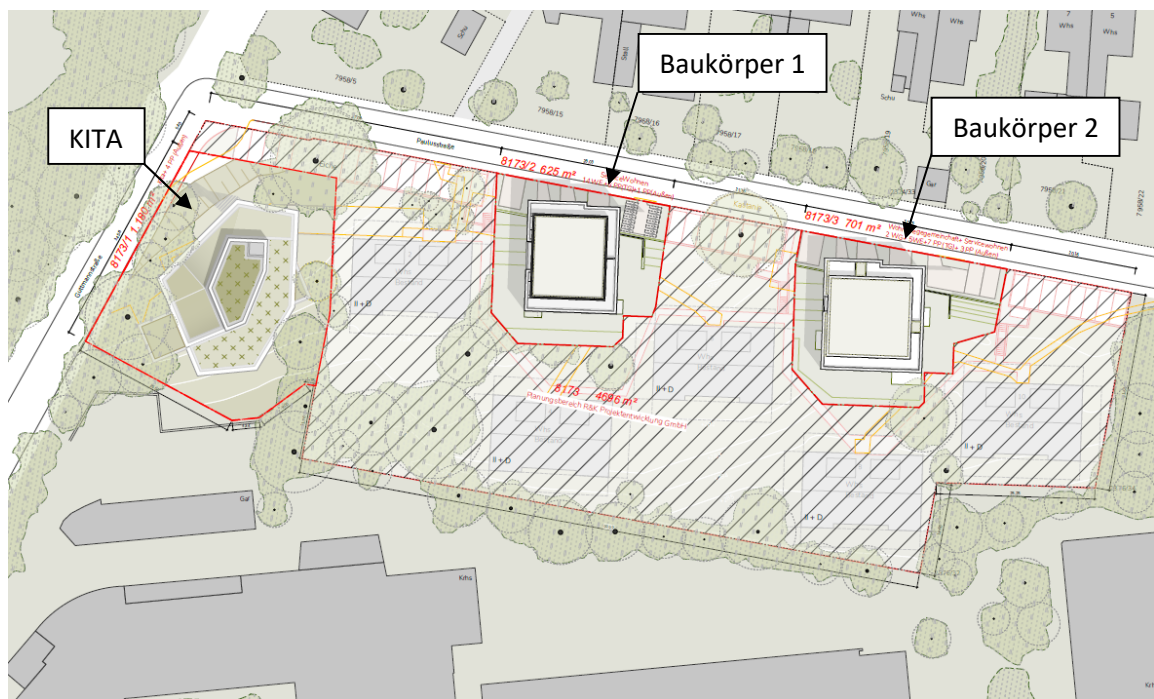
Lageplan vom 19.09.2024, © AP+M ARCHITEKTEN GmbH
